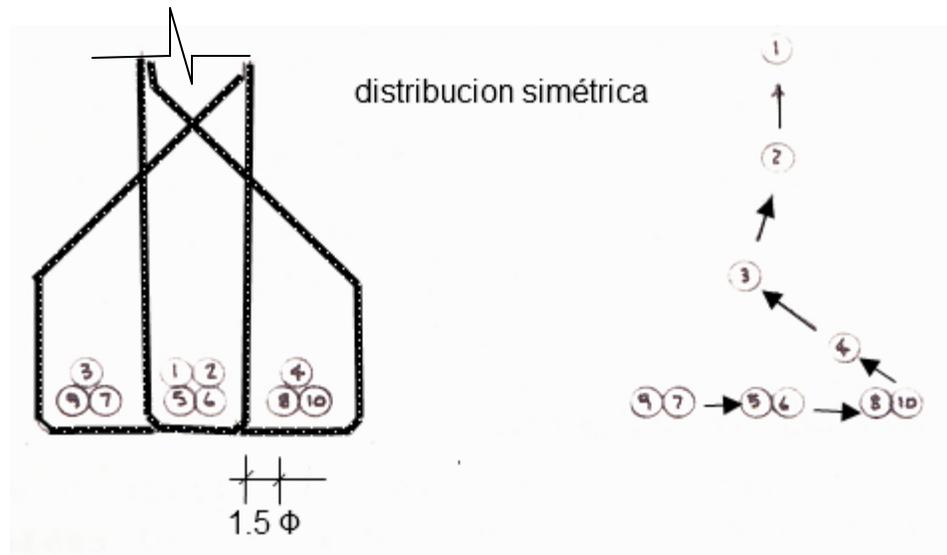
Detalle de paquetes de cables distribuidos en forma simétrica
